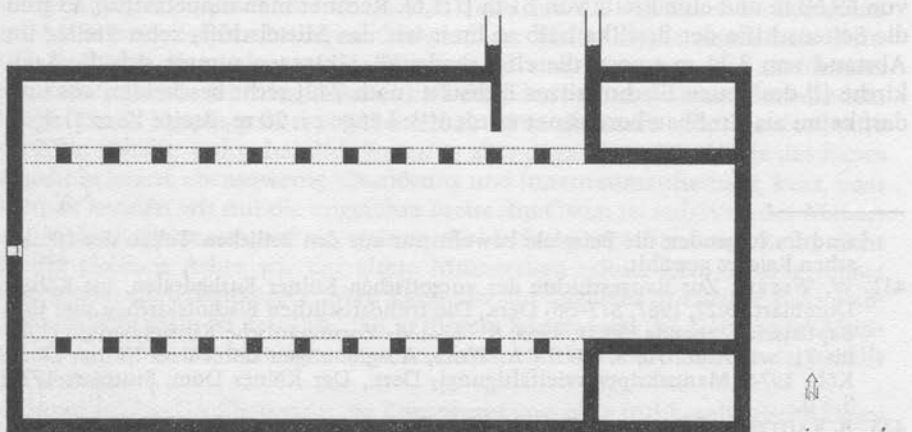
Worms, Dom, St. Peter und Paul, Bau I, 612–640, rekonstruierter Grundriß nach R. Kautzsch 1938, M. 1:500.
